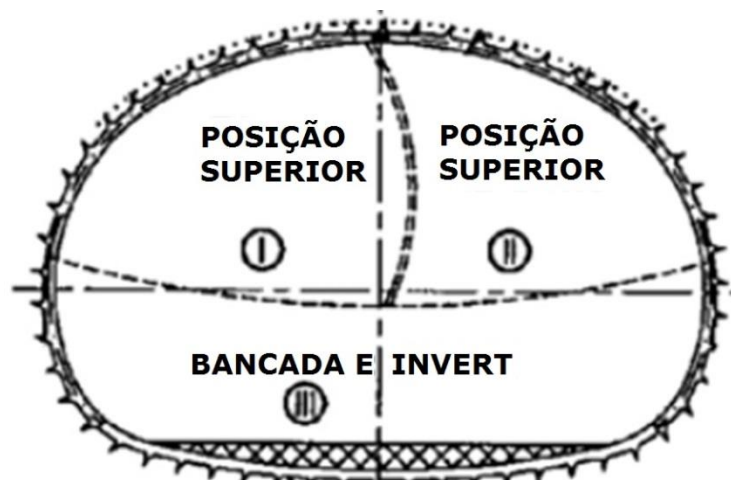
Subdivisão da escavação da seção transversal (modificado de Gall, 2008).
